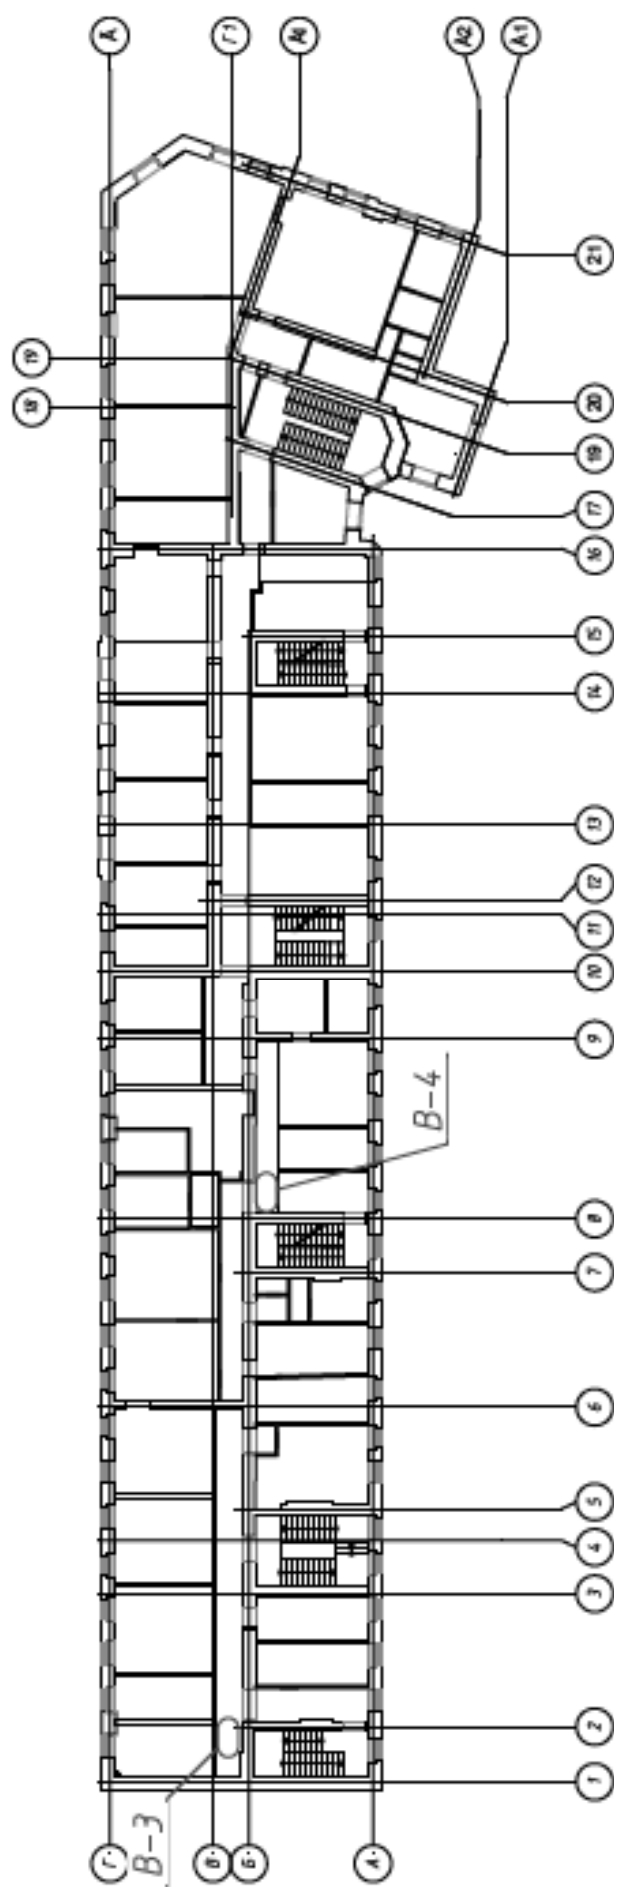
Схема расположения вскрытий 4-го этажа
